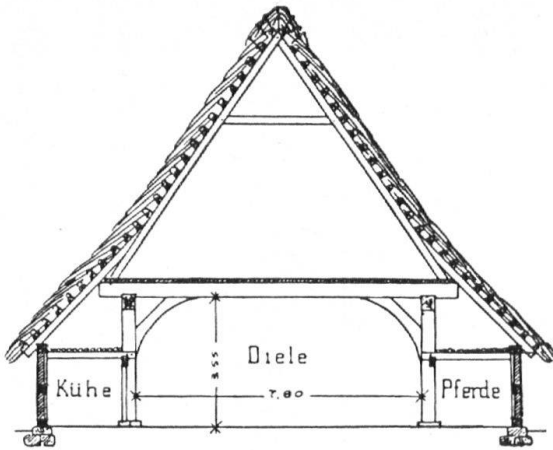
Nördliches Dachhaus. Der «Bock» trägt das Dachgerippe. Aus: Fiedler, Das Fachwerkhaus. — Fig. 6. Toiture d'une maison des régions du nord. La charpente repose directement sur les madriers d'appui. Extrait de Fiedler: La construction en pans de bois.
